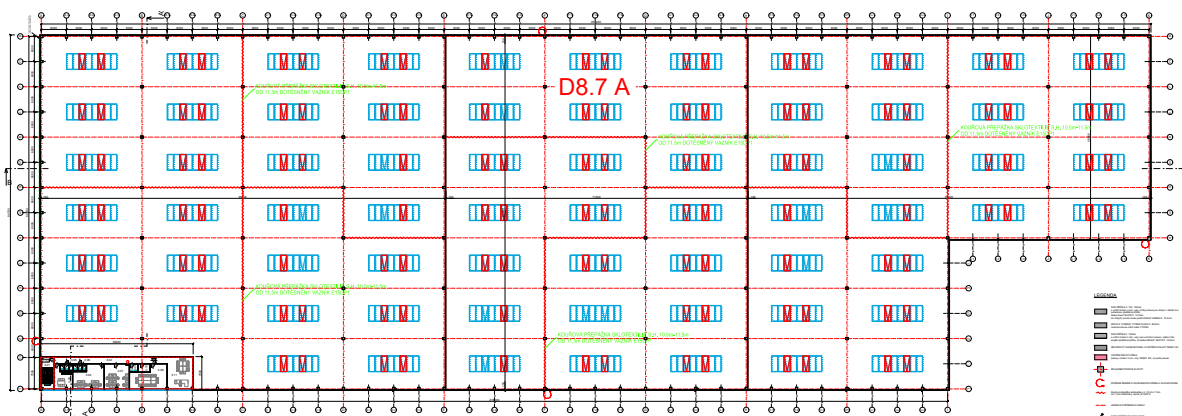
Hala D8-7A půdorys 2.NP vestavek [14]
